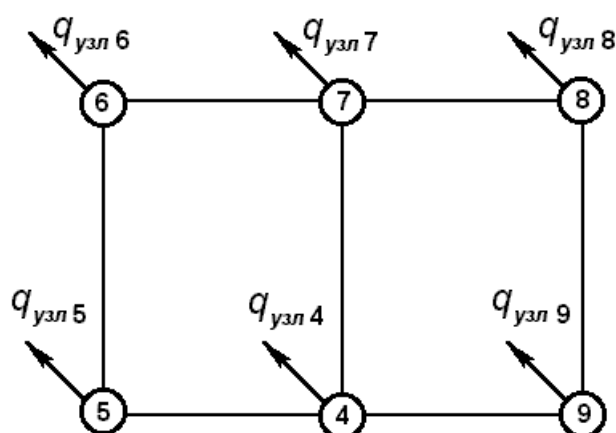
Расчетная схема водопроводной сети с узловыми расходами
